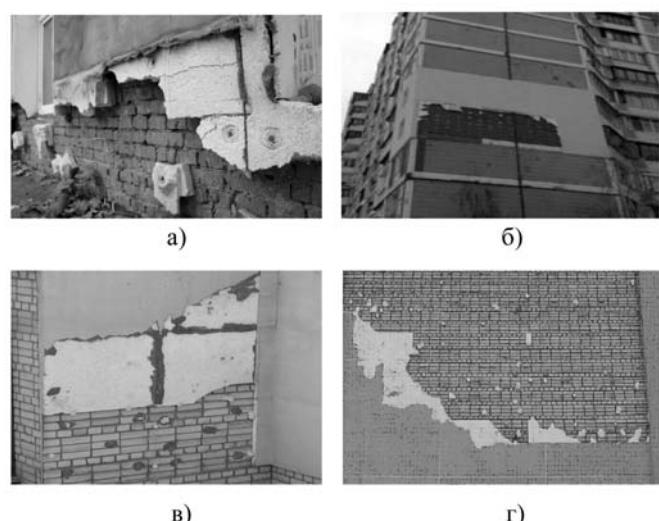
Фрагменты разрушенной системы «скрепленной теплоизоляции» на фасадах жилых зданий, утепленных пенополистирольными плитами
